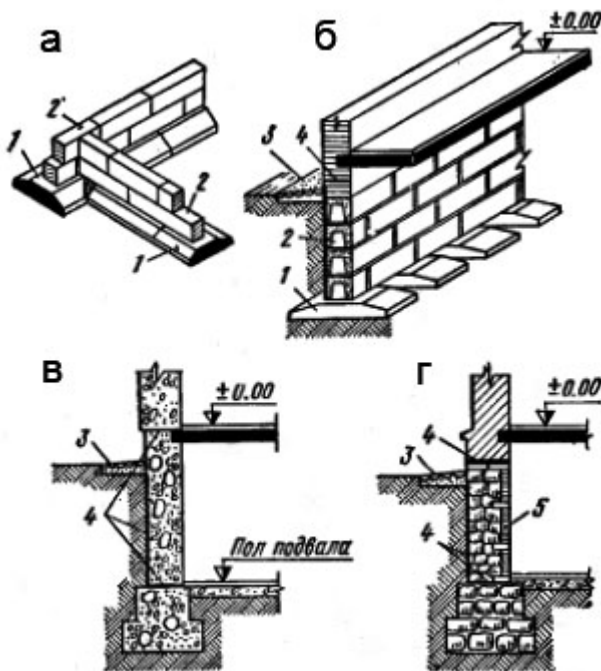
а-г. Варіанти конструкцій фундаментів дрібного закладання: 1 – подушка; 2 – монолітні або блочні стіни підвалу; 3 – відмостка; 4 – гідроізоляція; 5 – внутрішнє оздоблення стіни.
